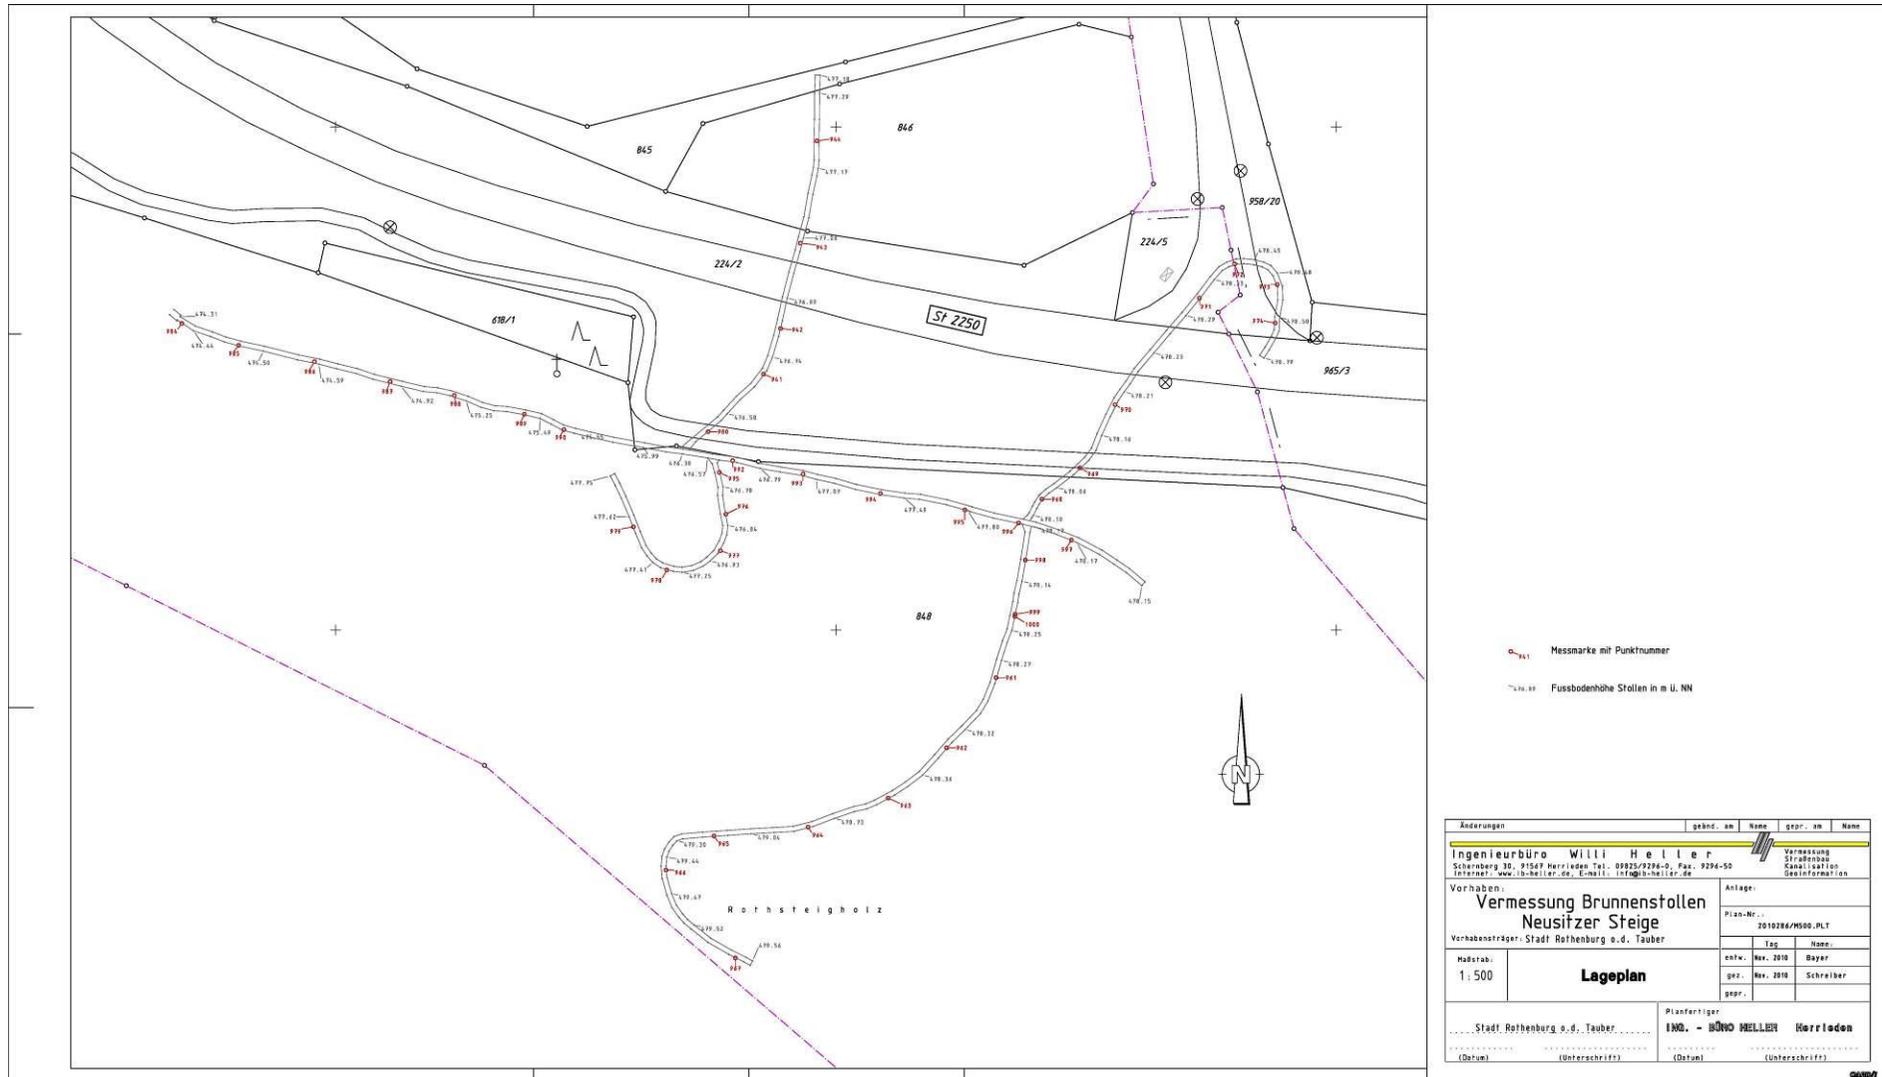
Lageplan des Neusitzer Stollens. Der Stolleneingang befindet sich links. (© Stadt Rothenburg o. d. Tauber)
